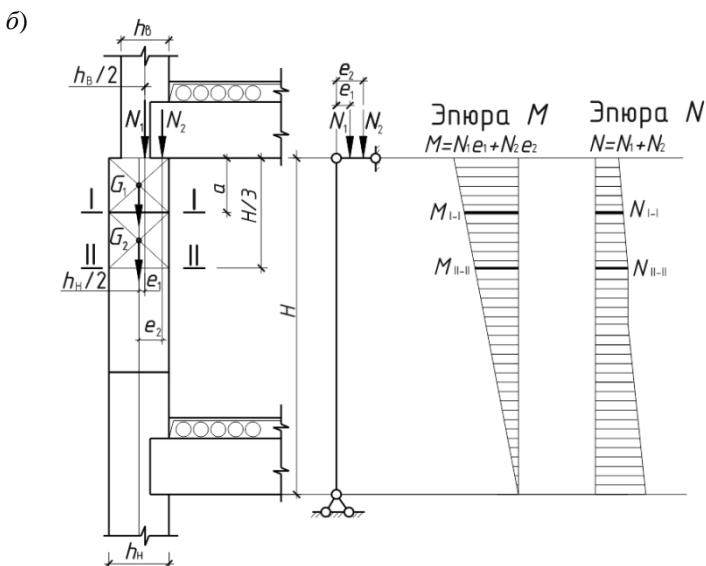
К расчету стены на вертикальные нагрузки:
